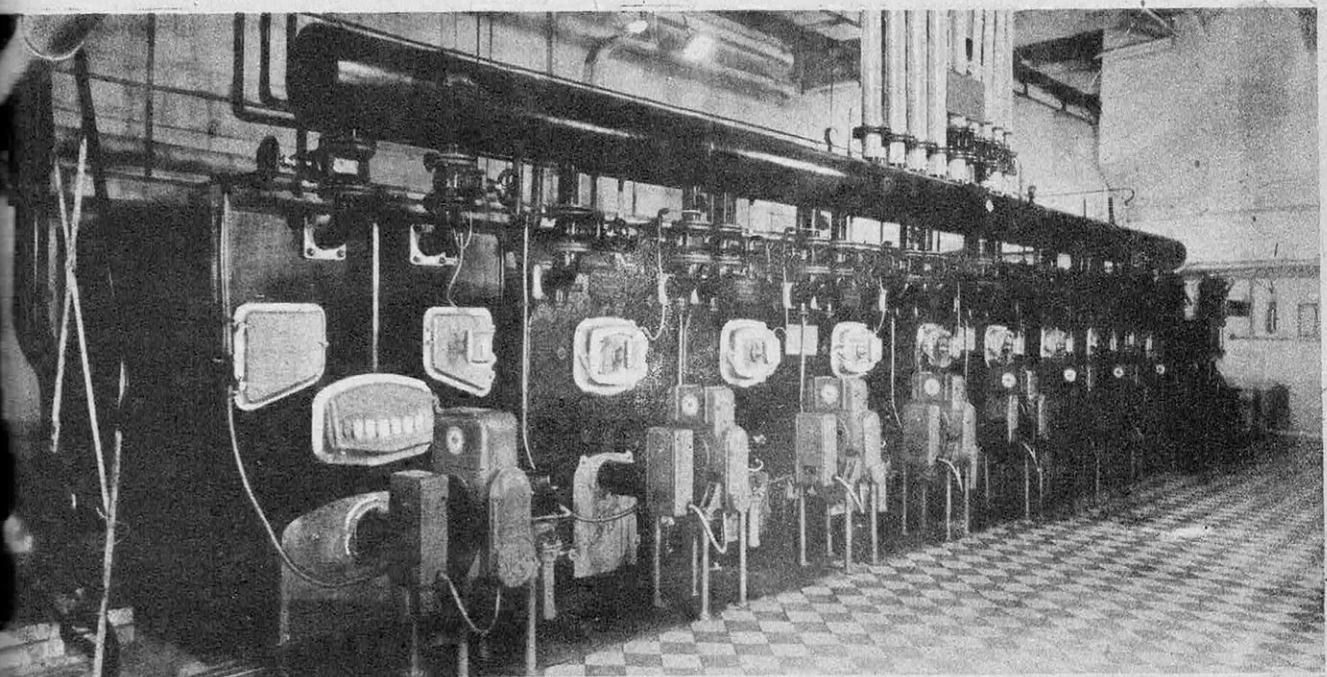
INSTALLATION DE CHAUFFAGE AU MAZOUT A EAU CHAUDE D'UNE PUISSANCE DE 1 800 000 CAL/H
